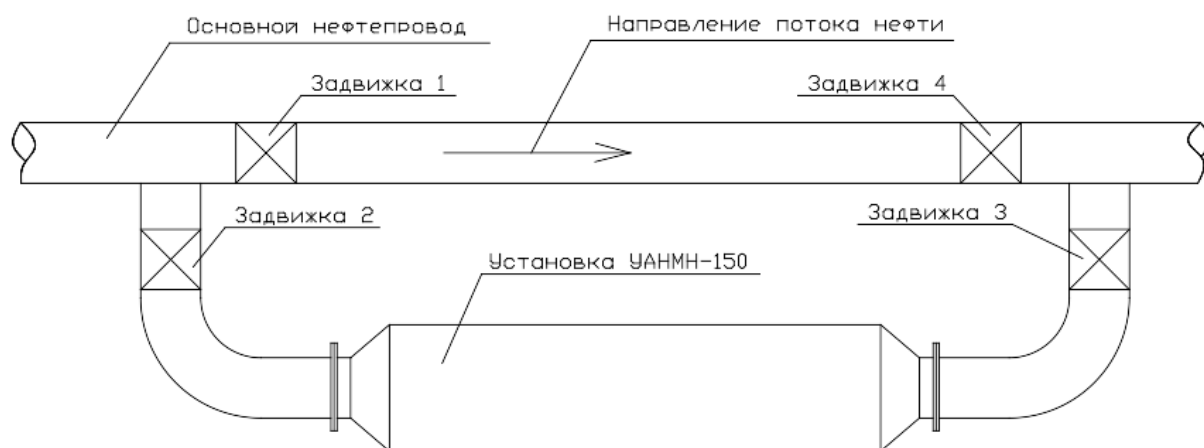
б)– Схема подключения установки к нефтепроводу
